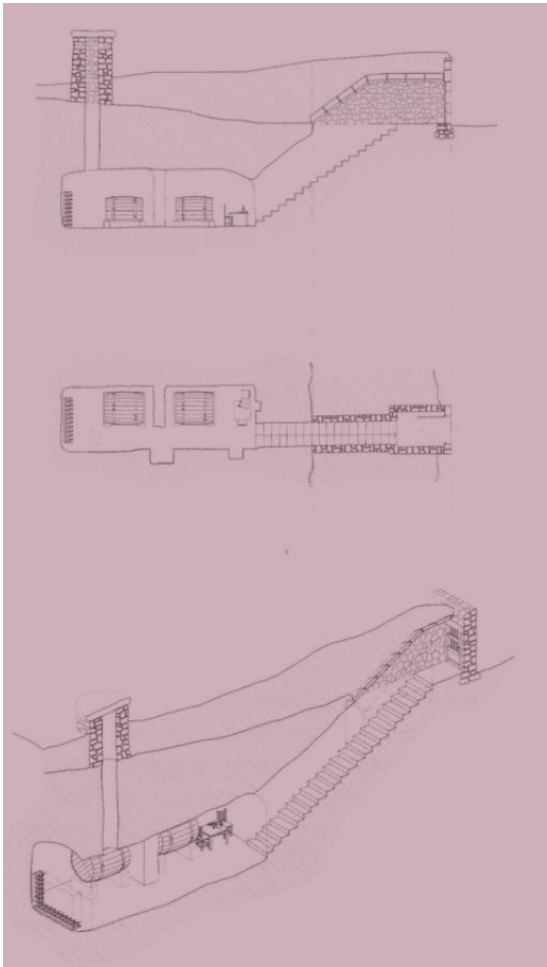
Esquema de bodega tipo excavada tradicional. (Fuente: Félix Jové, 2021).
